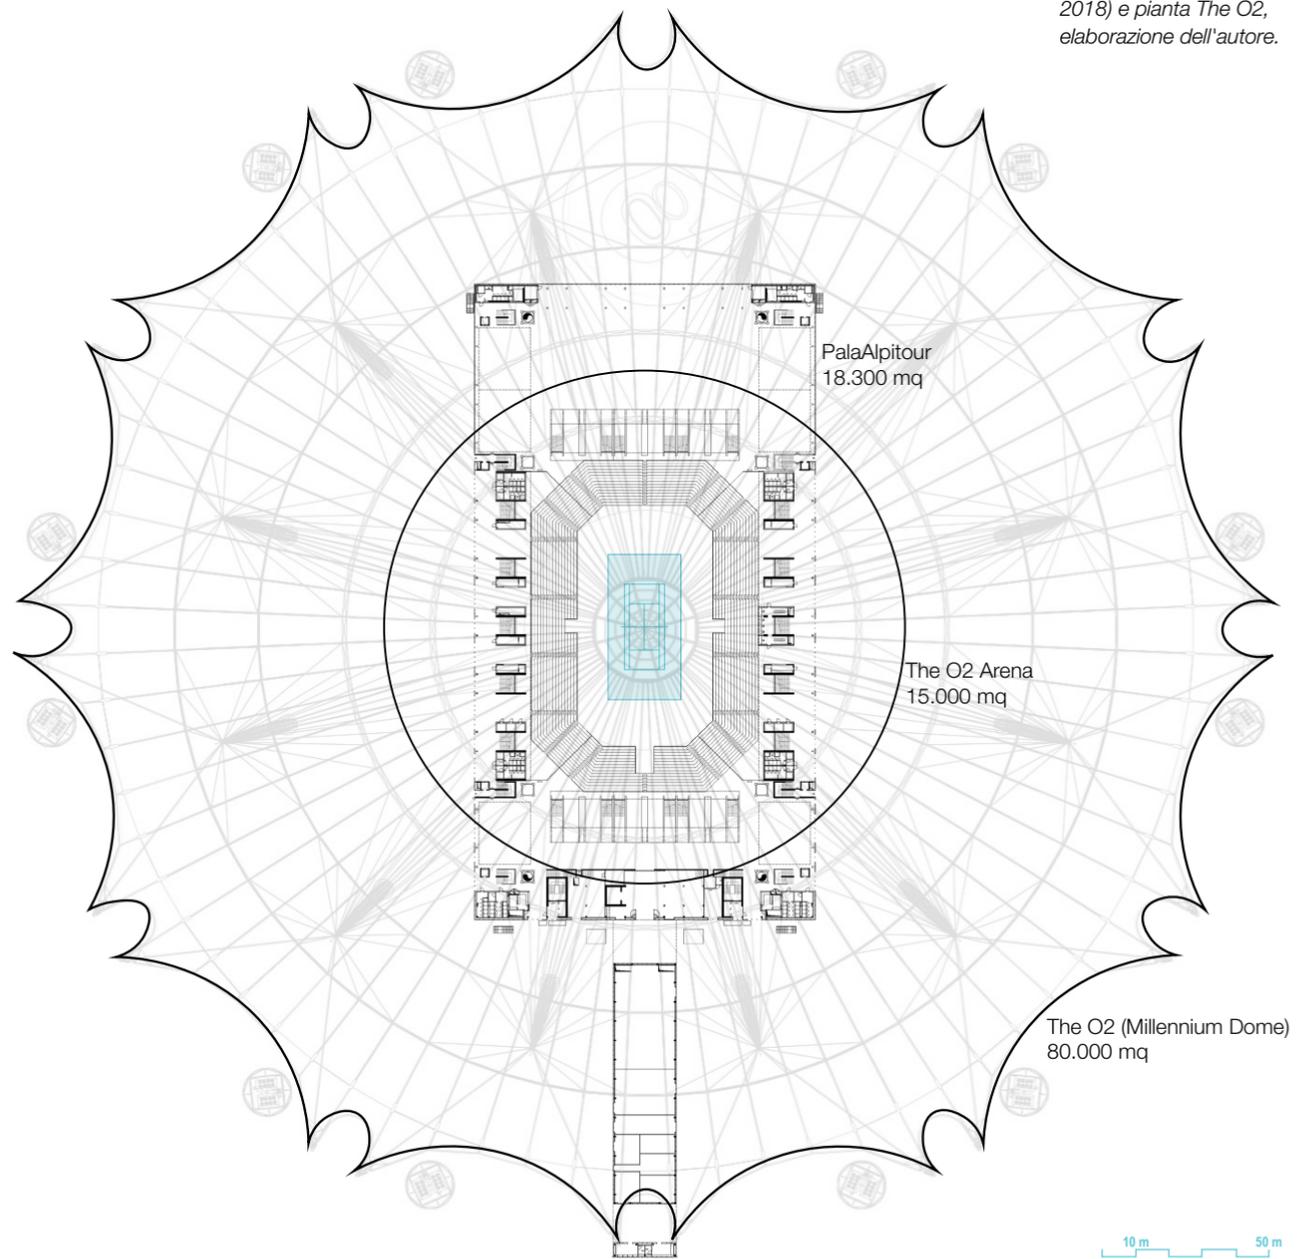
Sovrapposizione pianta PalaAlpitour e Pianta The O2 con la O2 Arena, elaborazione dell'autore.
